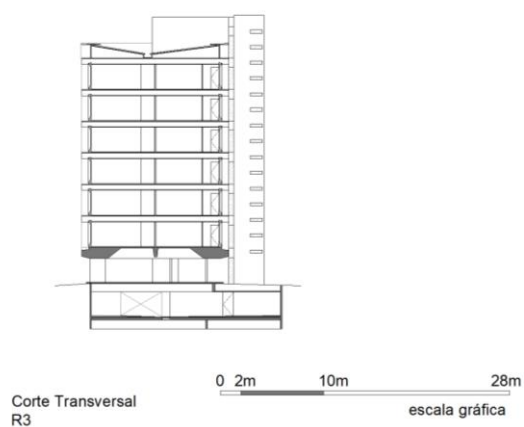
Corte transversal do R3. Fonte: da autora, adaptado das pranchas originais do Acervo do Arquiteto Milton Ramos.
